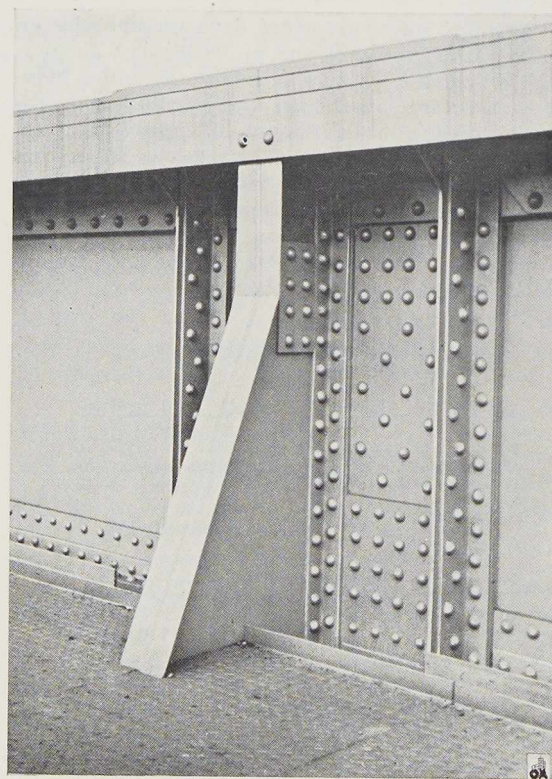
Assemblage de pièce de pont. Poutre principale.
